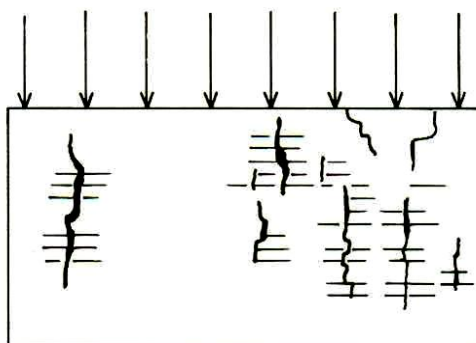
Fissuras verticais por sobrecarga vertical uniforme
